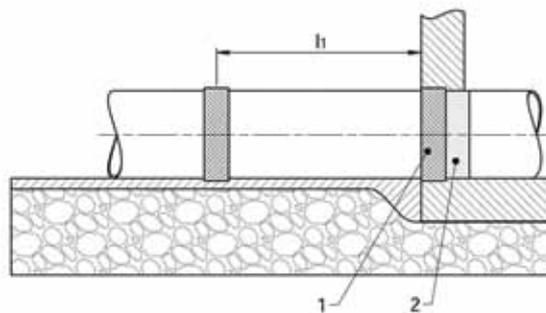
Anschluss an Bauwerke mit Mauerwerkskupplungen
